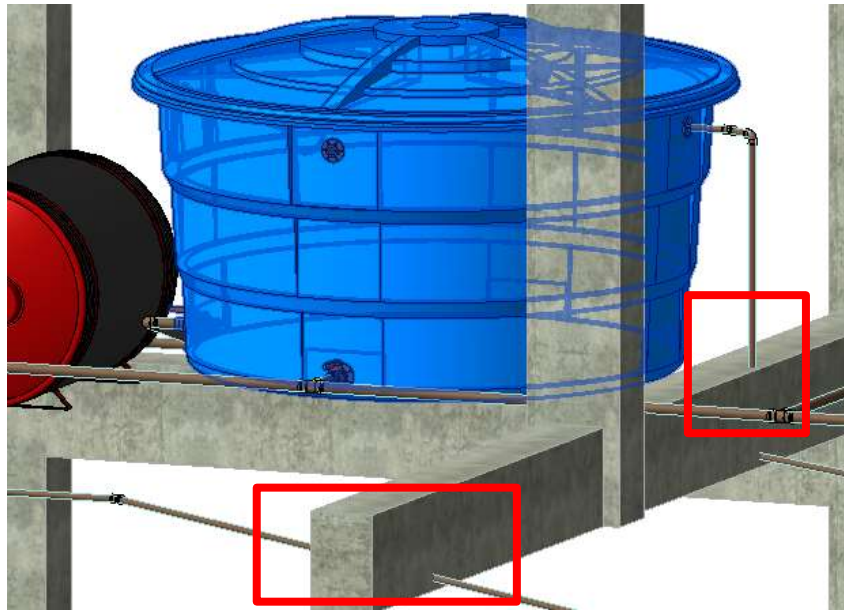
Elementos estruturais com a malha hidrossanitária.
